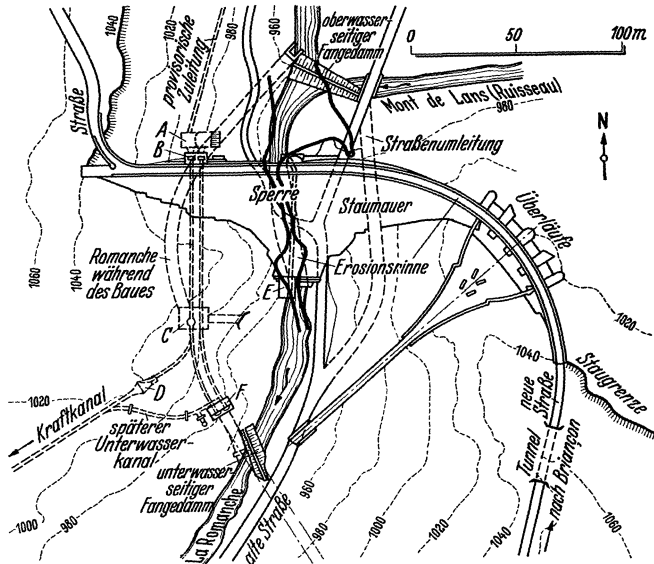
Chambon-Stauanlage (Frankreich). Lageplan mit Erosionsrinne.
